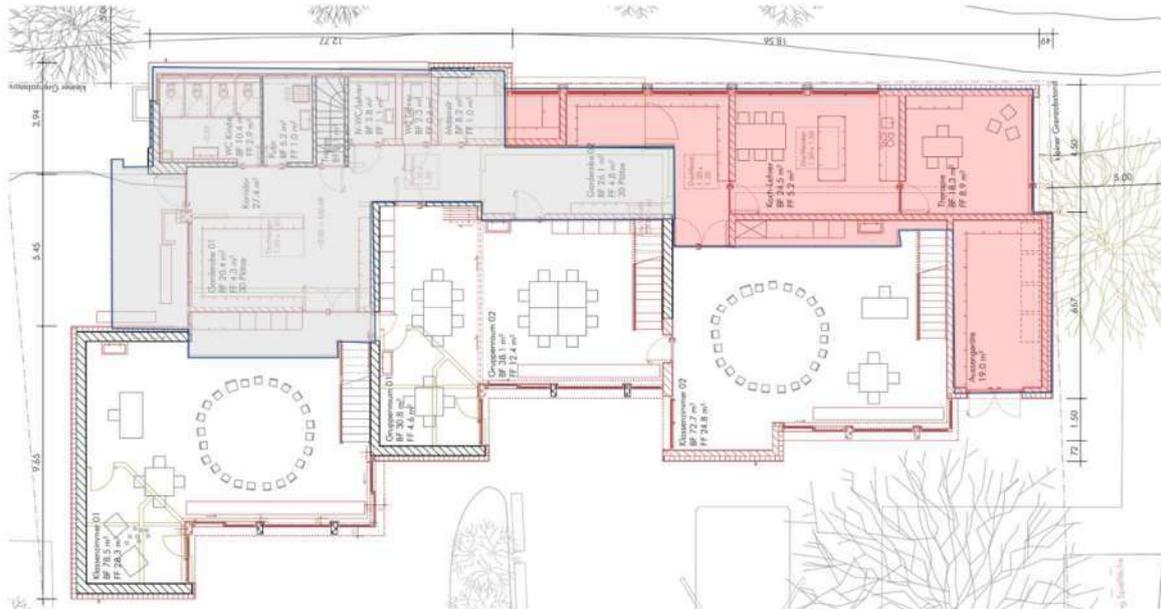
Grundriss EG - Übersicht der geplanten Massnahmen (grau: bestehende Decke über EG, rot: neu Decke über EG)
